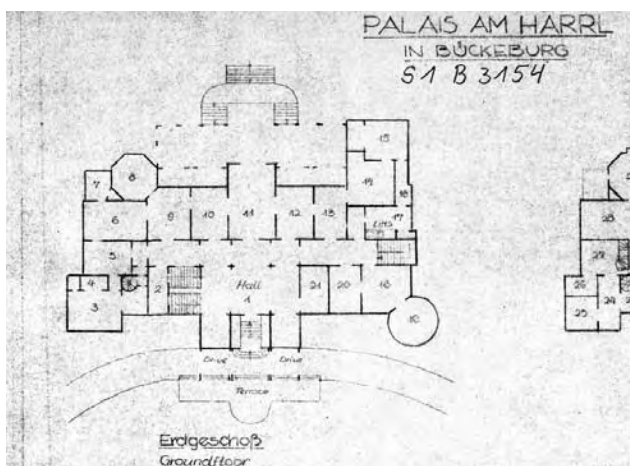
Neues Palais in Bückeburg, Grundrisse (NLA – StA Bückeburg S 1 B Nr. 3184 Bl. 1).
